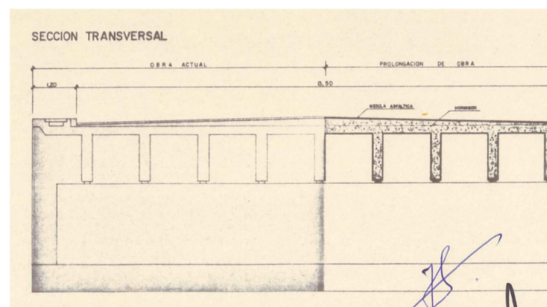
Sección transversal (Fuente: Proyecto Modificado: Mejora y ensanche del firme CN630, de Gijón a Sevilla PK 326,500 al 384,800. Tramo: León-Puerto de Pajares)
